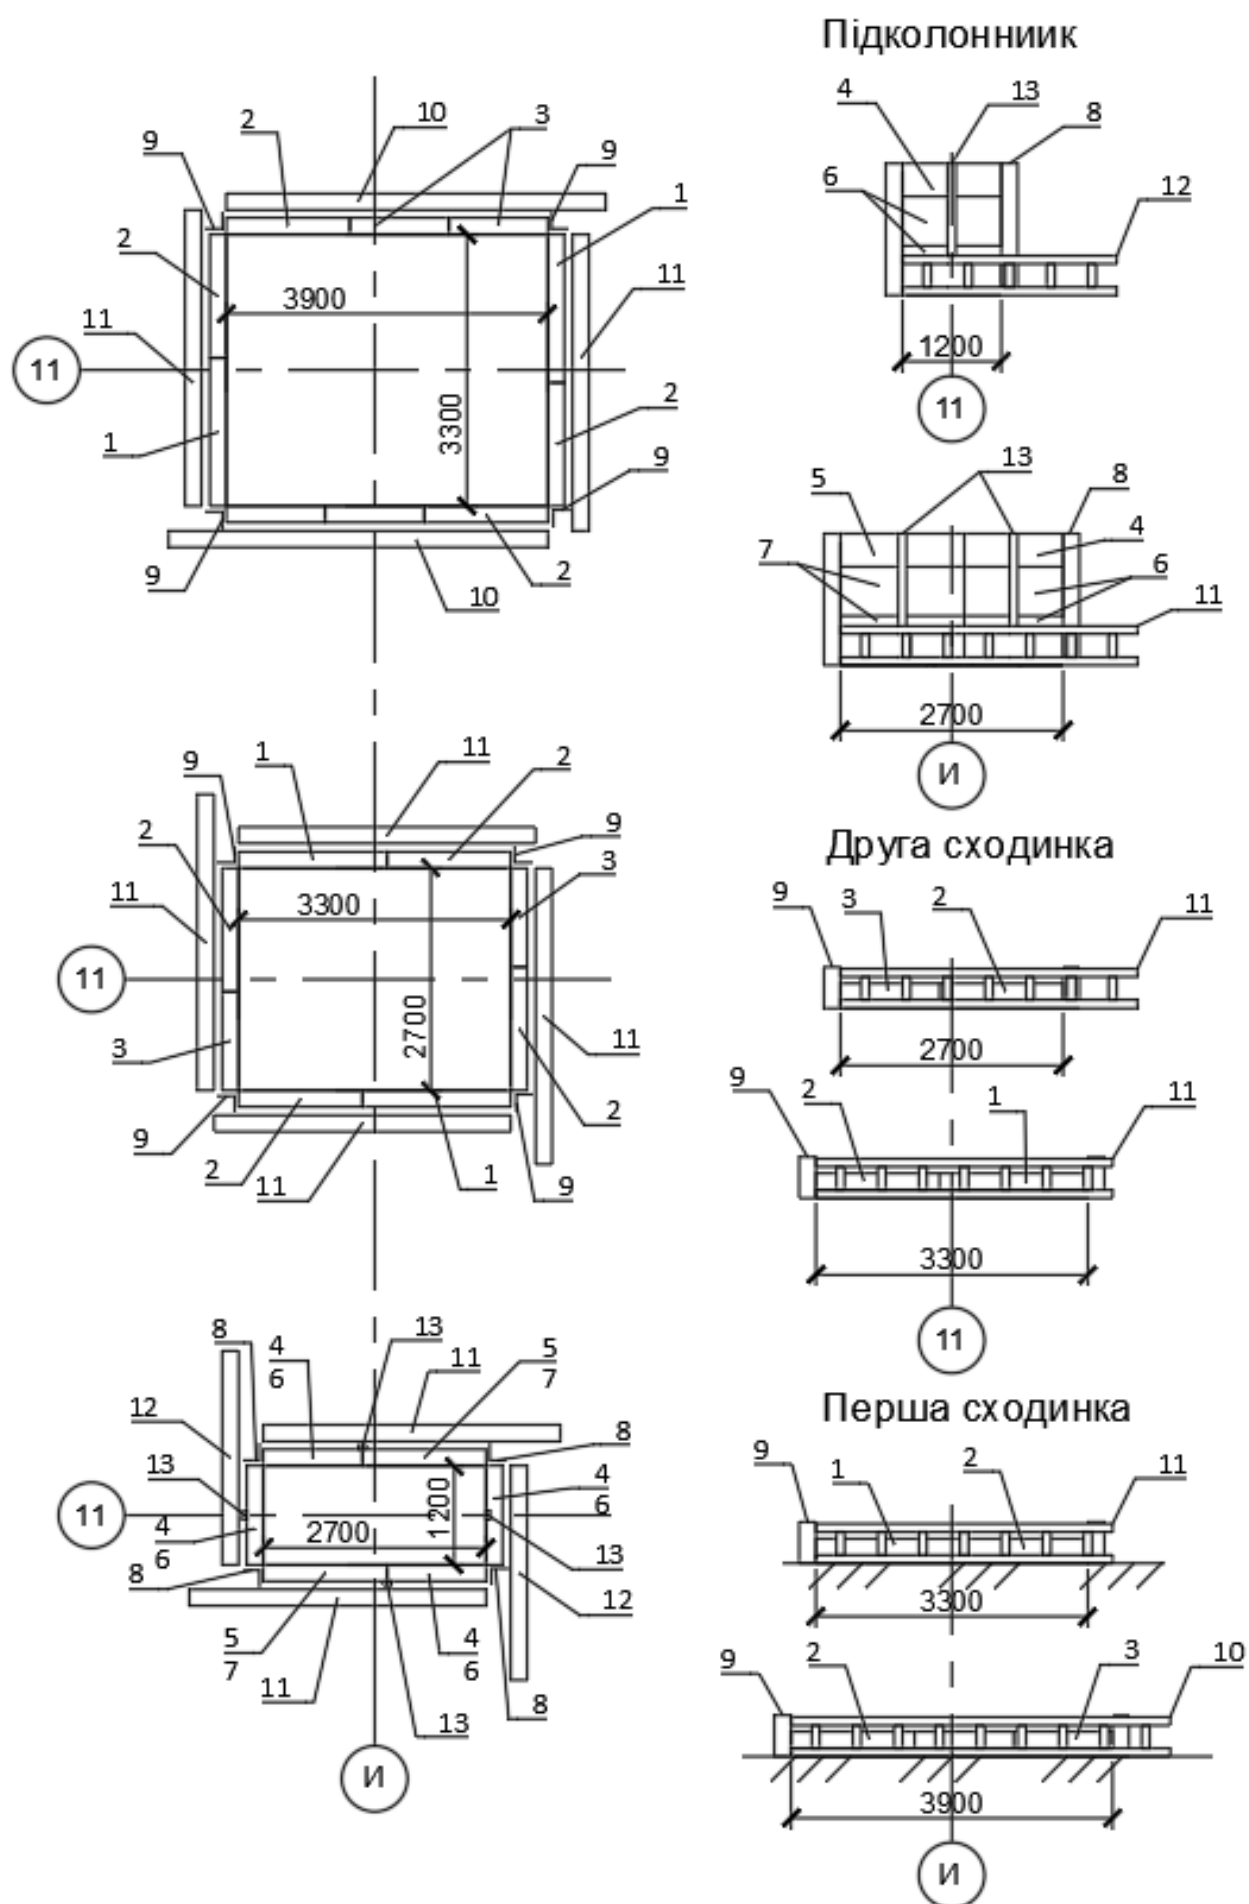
Маркувальна опалубочна схема ступінчастого фундаменту
